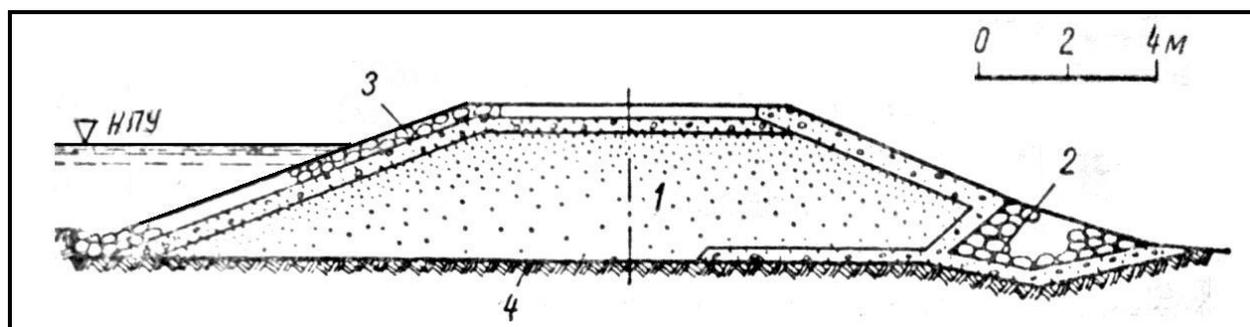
Насыпная дамба № 3 водохранилища Келси на р. Нельсон, Канада, 1961 г. Высота дамбы 6 м. [19]
